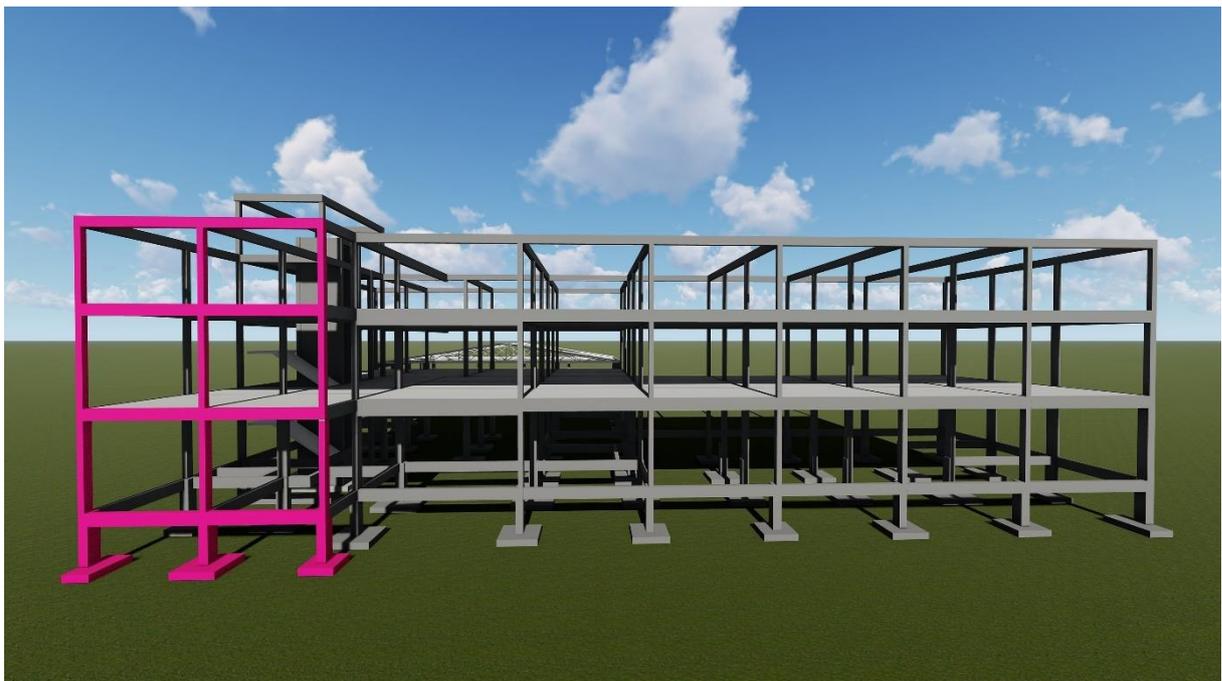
Proyecto ejecutivo: pórtico 1 a ser verificado.
